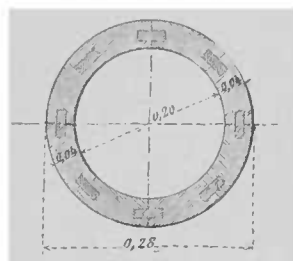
Coupe des conduites en bois entre Pfäfers et Ragaz.
